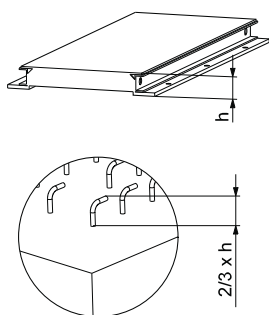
Усиливающие стальные стержни, устанавливаемые в фундамент
